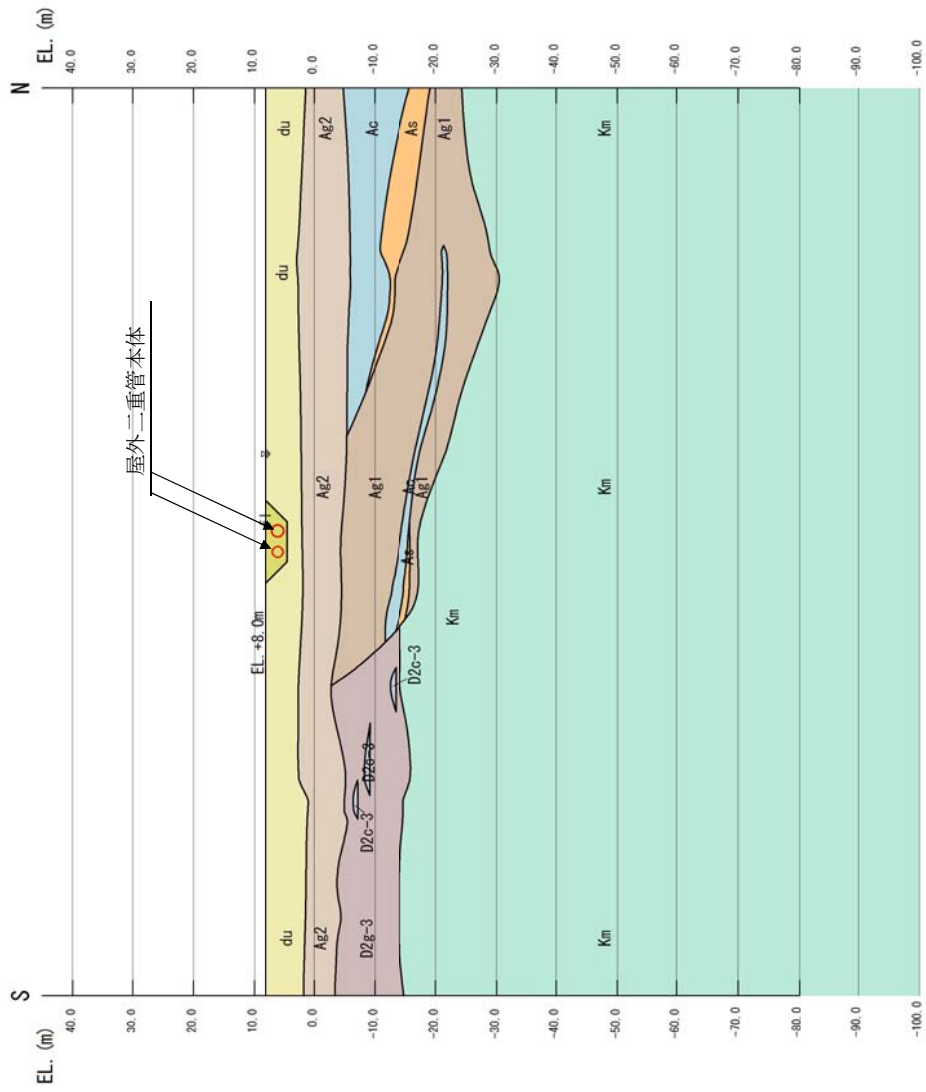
(3) 地质断面图 (C-C' 断面, C'-C' 断面)
